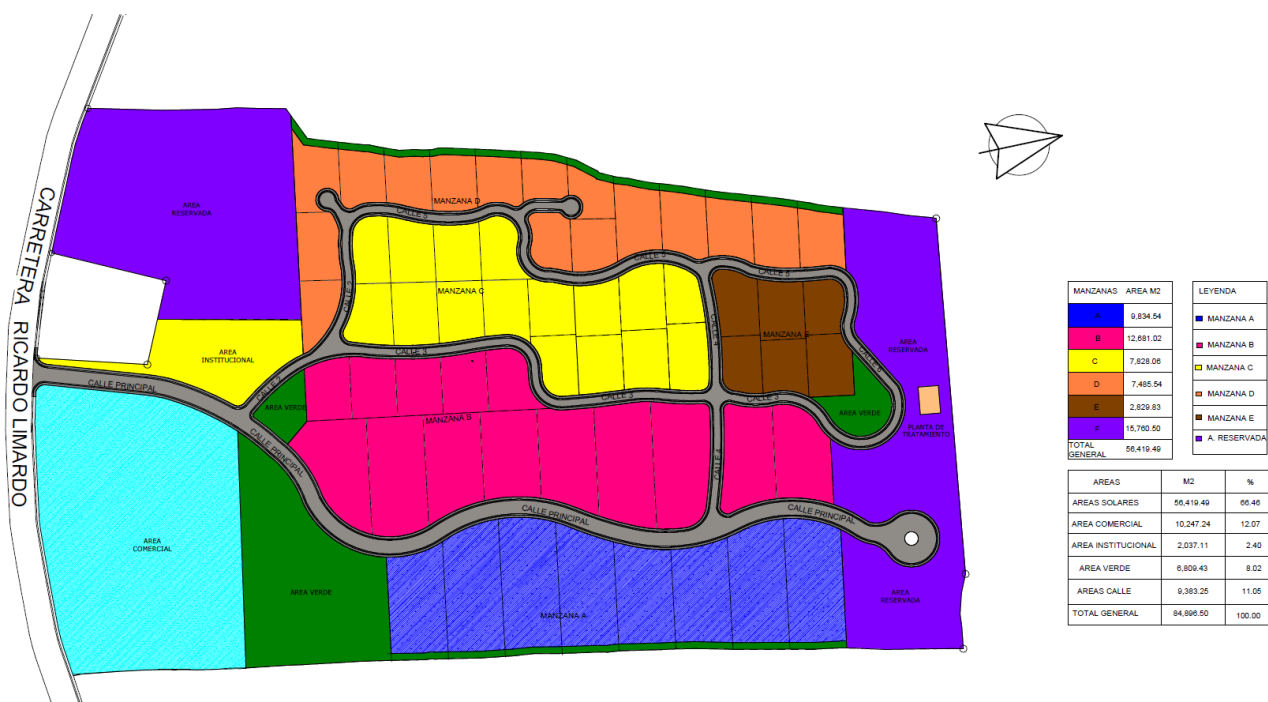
Plano de conjunto del proyecto, indicando zonas.
